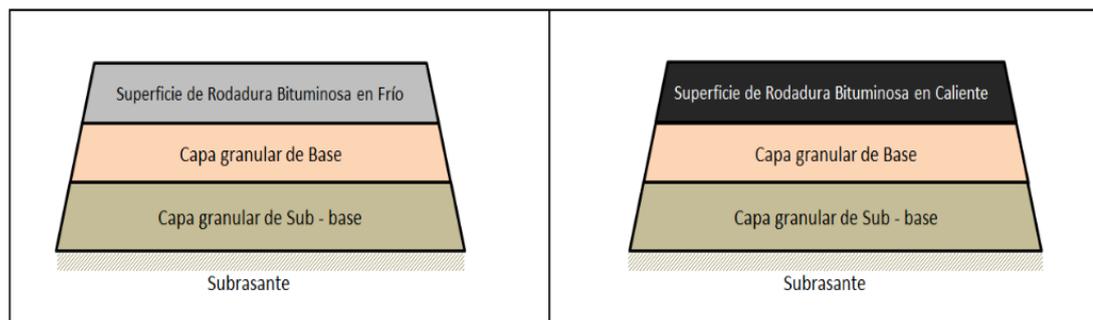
Clasificación de Capas del Pavimento Flexible.
